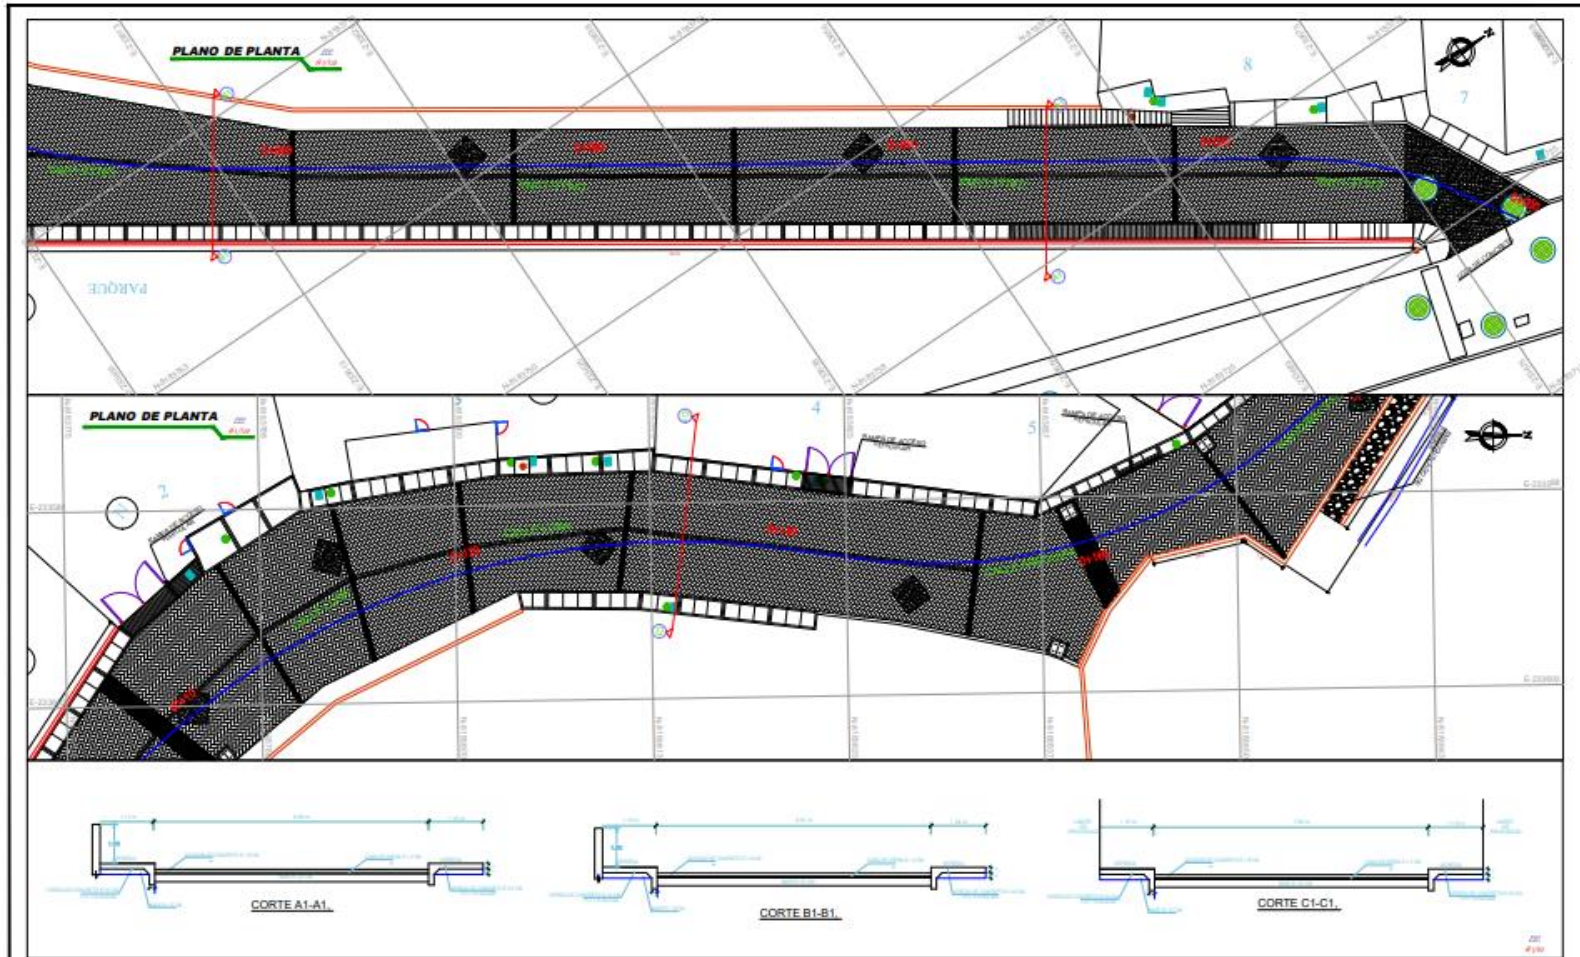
Planimetría de la construcción de muros de contención tramo 1 .A1.
